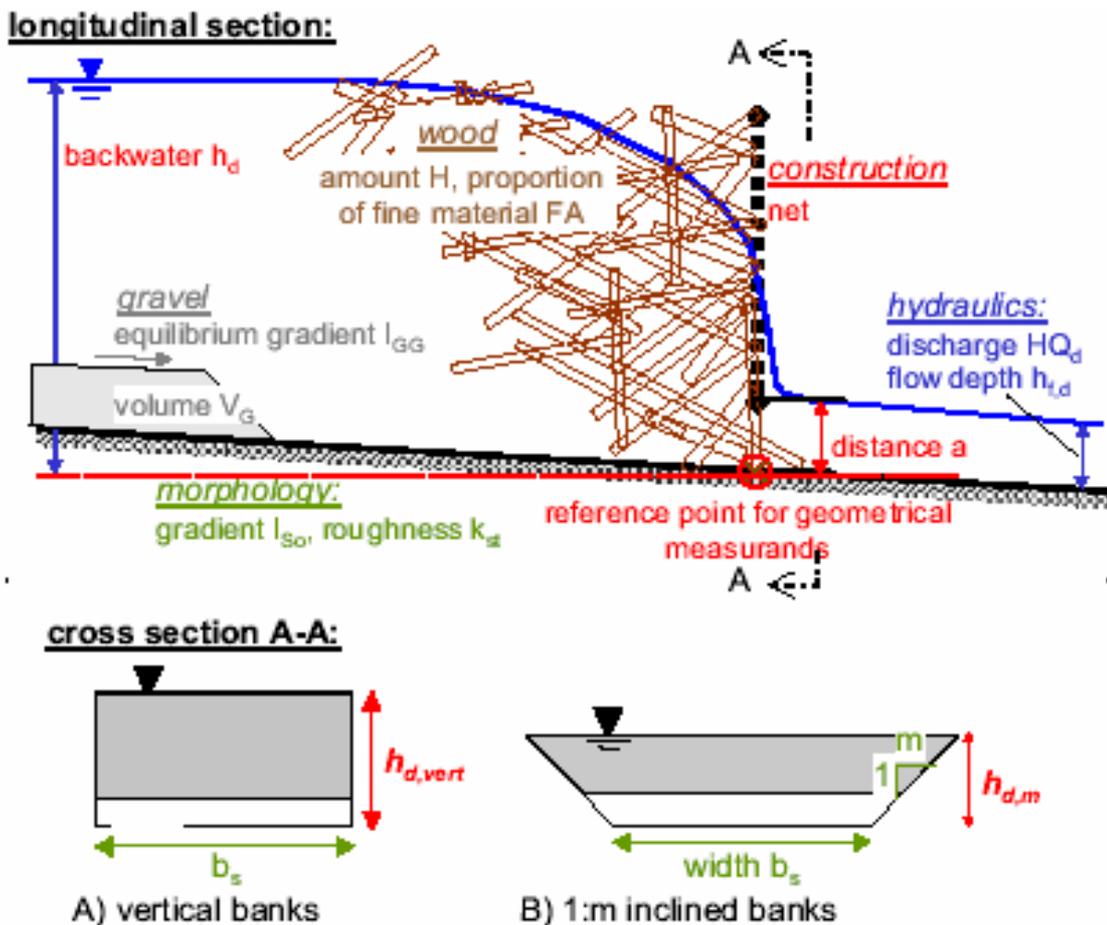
Perfil longitudinal y secciones transversales en la disposición de la red (Rimböck, 2004).
